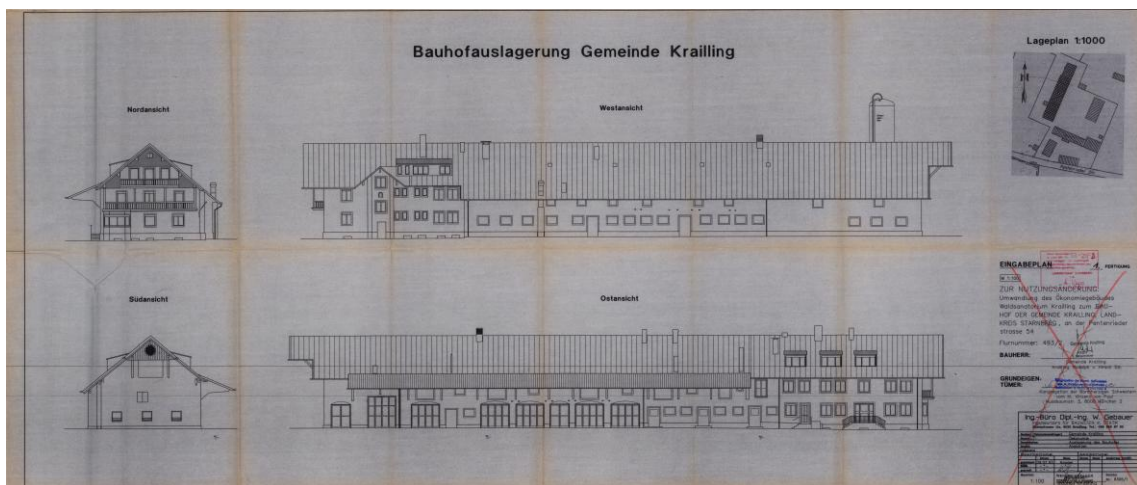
Ansichten zu den Um- und Ausbaumaßnahmen, (Genehmigungsbescheid 24.08.1993) Quelle: Gemeinde Krailling
